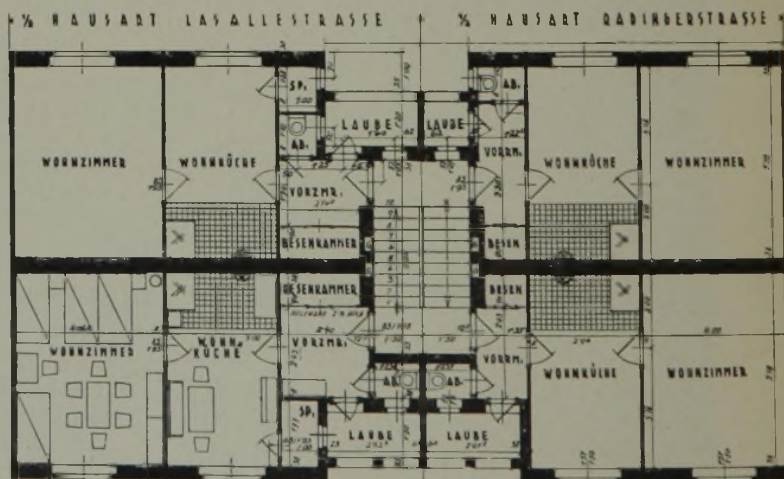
Entwurf aus dem Wettbewerb der Gemeinde Wien. Verf.: Arch. Z. V. Hauser u. Judtman, Wien. (M. 1 : 200.)
